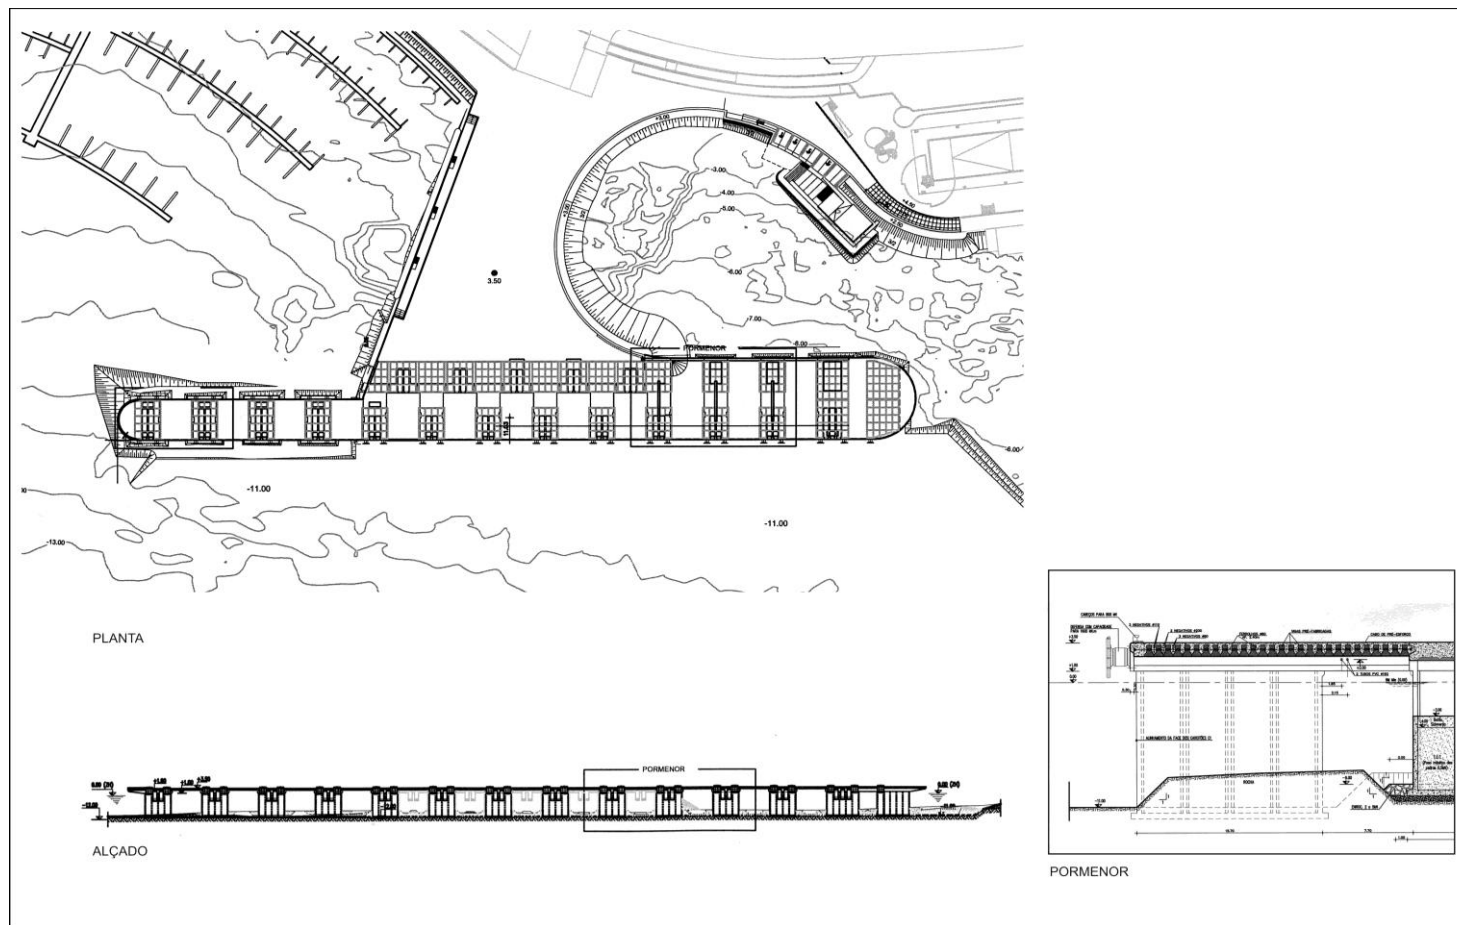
Planta referente ao terminal de cruzeiros e respetivo perfil tipo em estudo – ponto D4 (Fonte: Projeto Consulmar).
